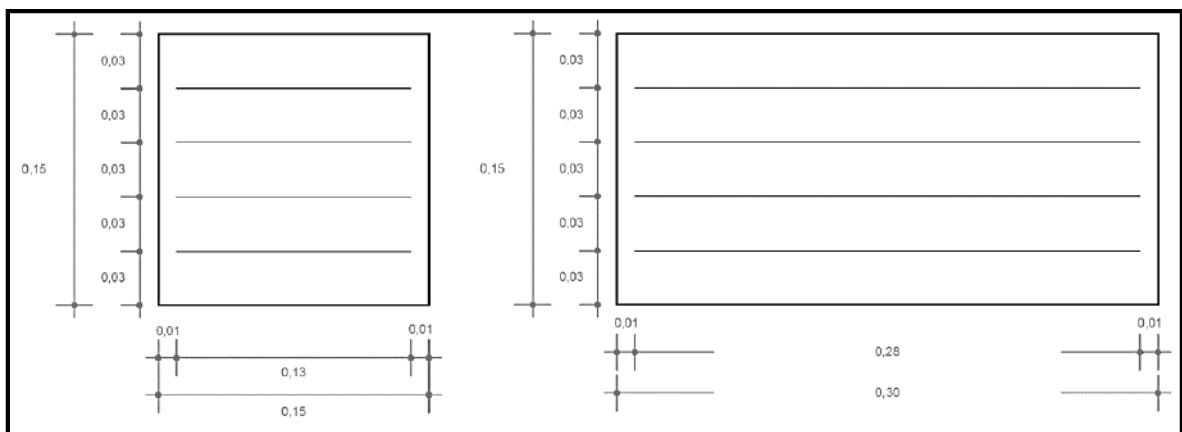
Corte transversal y longitudinal – Bloque de 4 mallas
